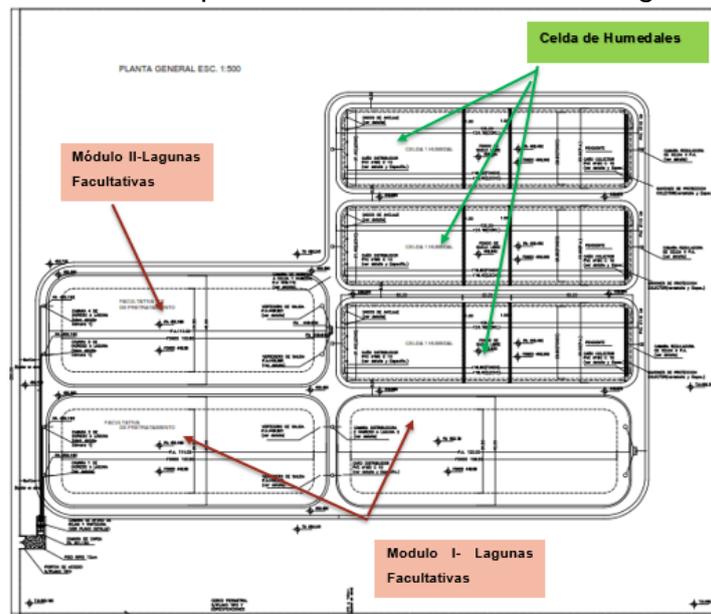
Planta general de Planta existente de efluentes cloacales. - Fuente: Propia.
